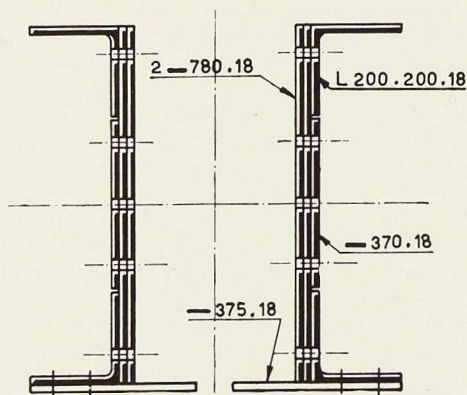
Section transversale de la membrure inférieure du pont de Krapina.
